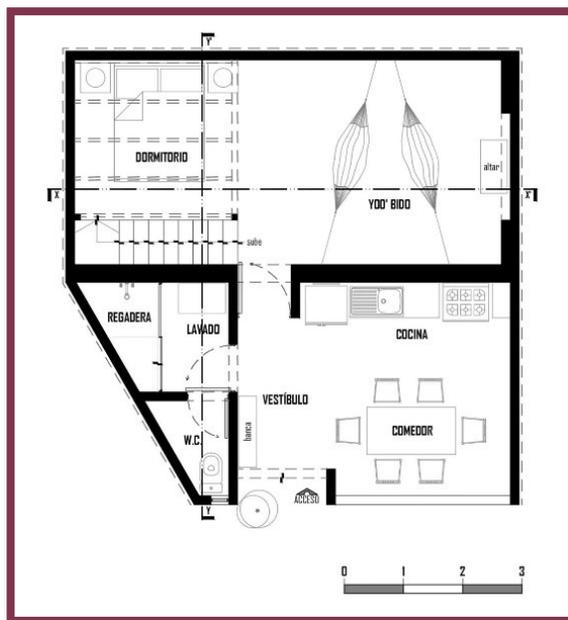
Planta arquitectónica de la vivienda Guenda Racané Saa. Elaboración propia
